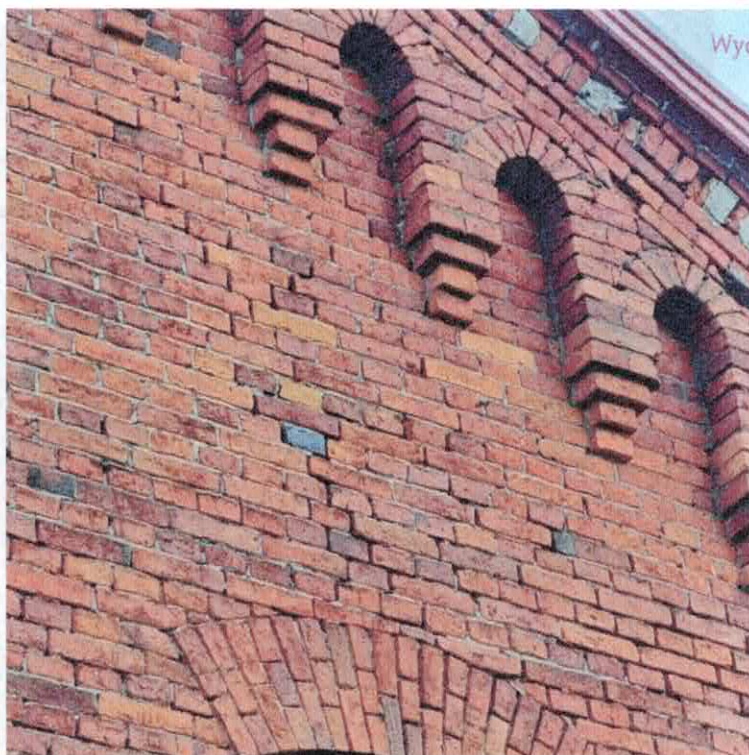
Widok przedstawiający ogólny stan zniszczenia gzymsu - attyki muru kościoła na elewacji wschodniej, widoczny ubytek cegieł w górnej warstwie muru oraz brak spoinowania
